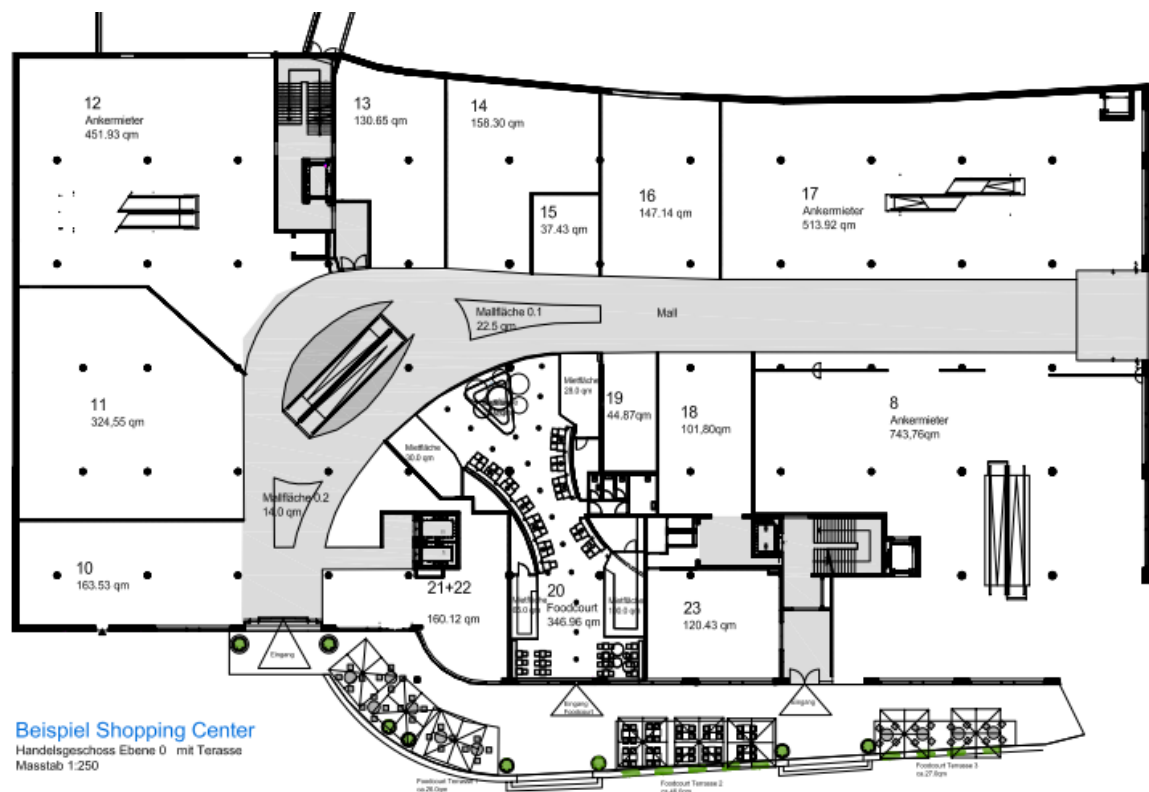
Grundriss Erdgeschoss Beispiel Shopping Center
